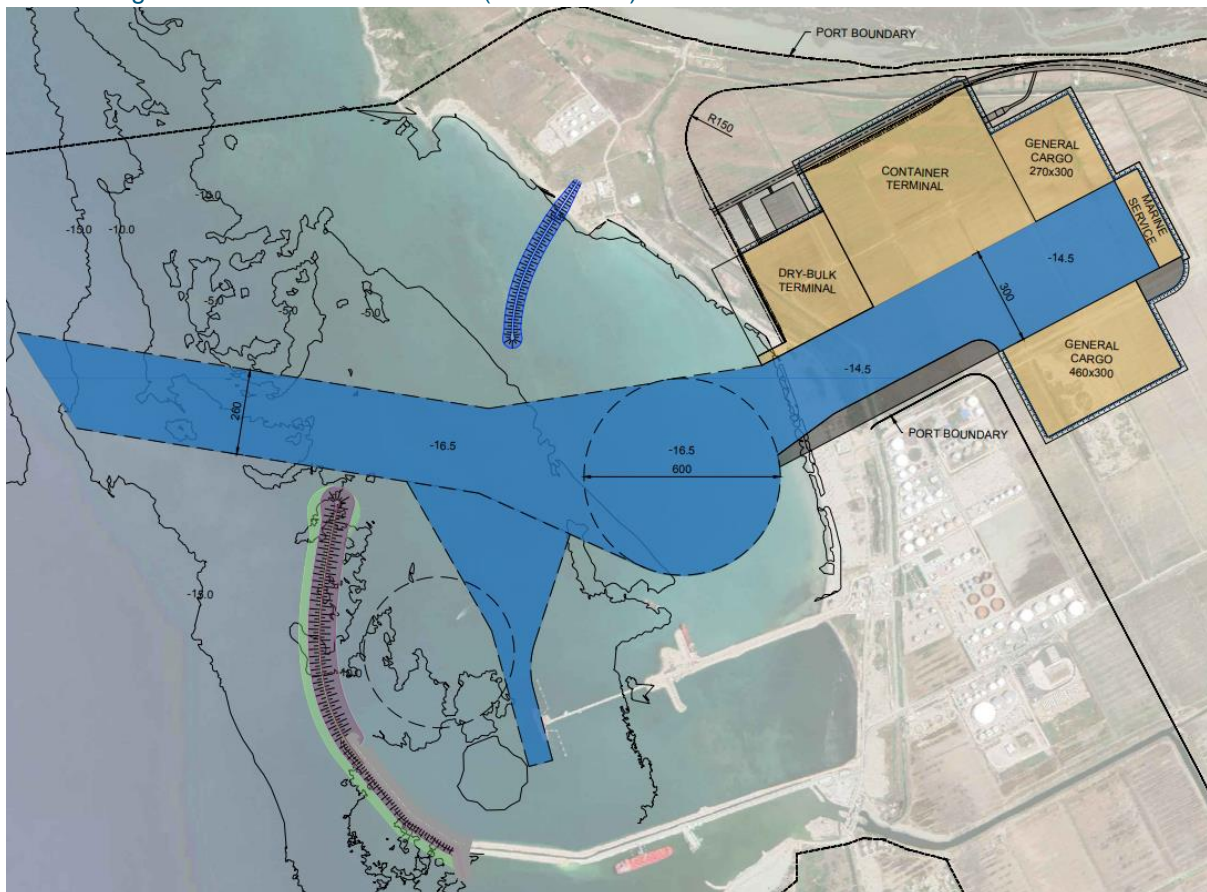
Planimetri e përgjithshme e Fazës 1
